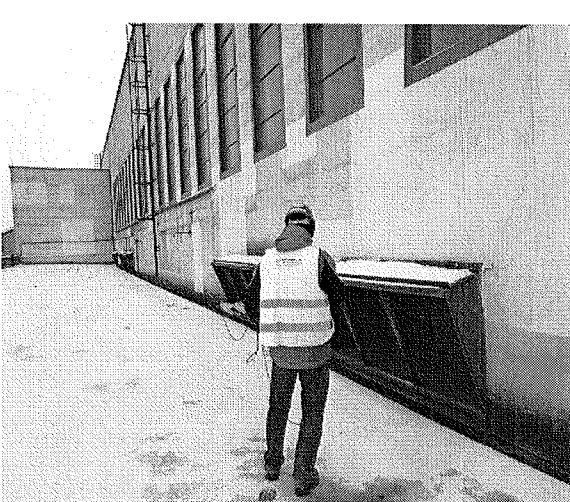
Kotelná EMĚ I, sání vzduchových ventilátorů
